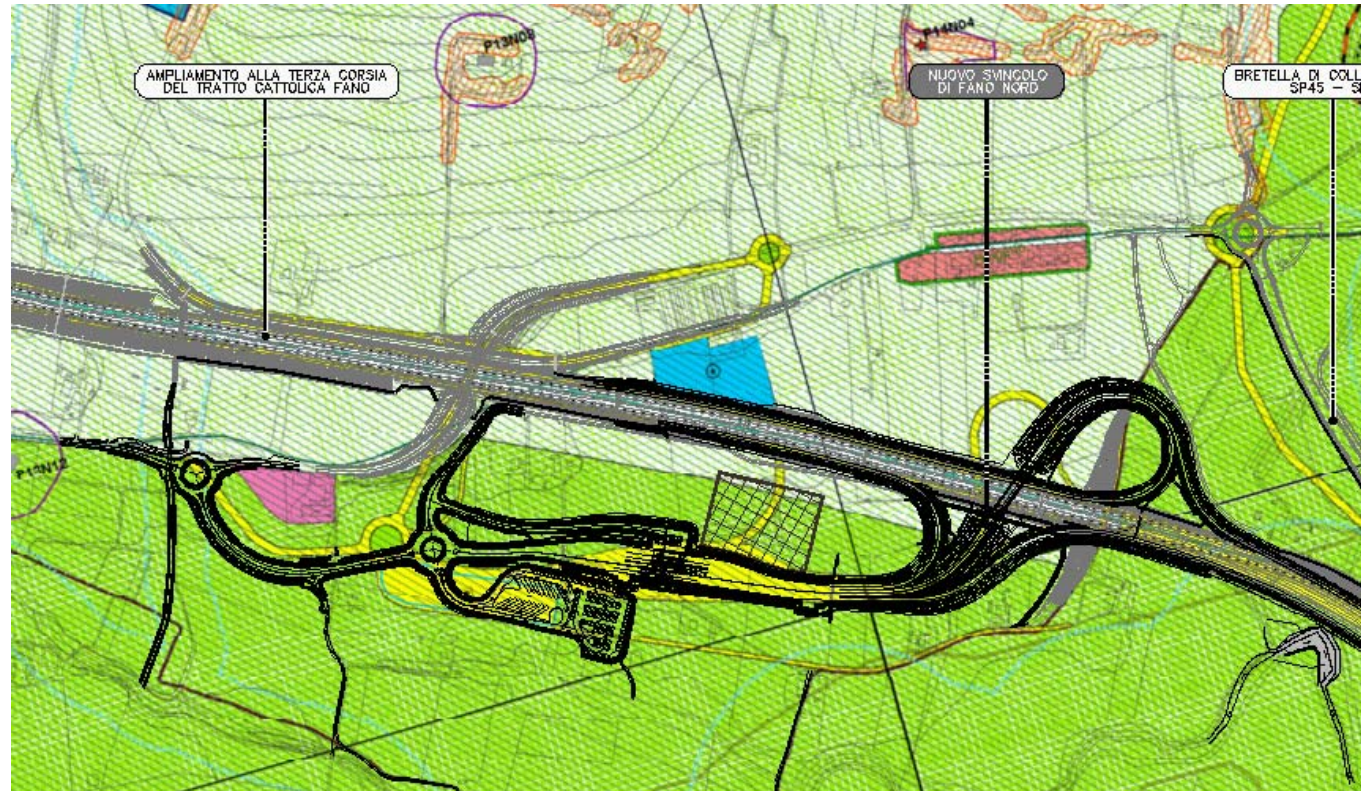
sovrapposizione planimetria- PRG (MAM-QPRM-009)
